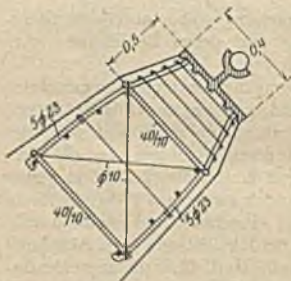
Bewehrung des Widerlagers unter einem eisernen Lagerstuhle.
